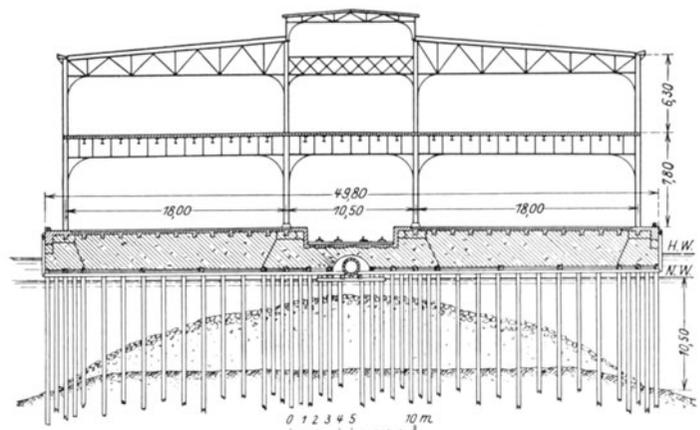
Zweigeschossiger Pier mit hohen Beton-Querrippen und Schüttung auf ganze Länge.
